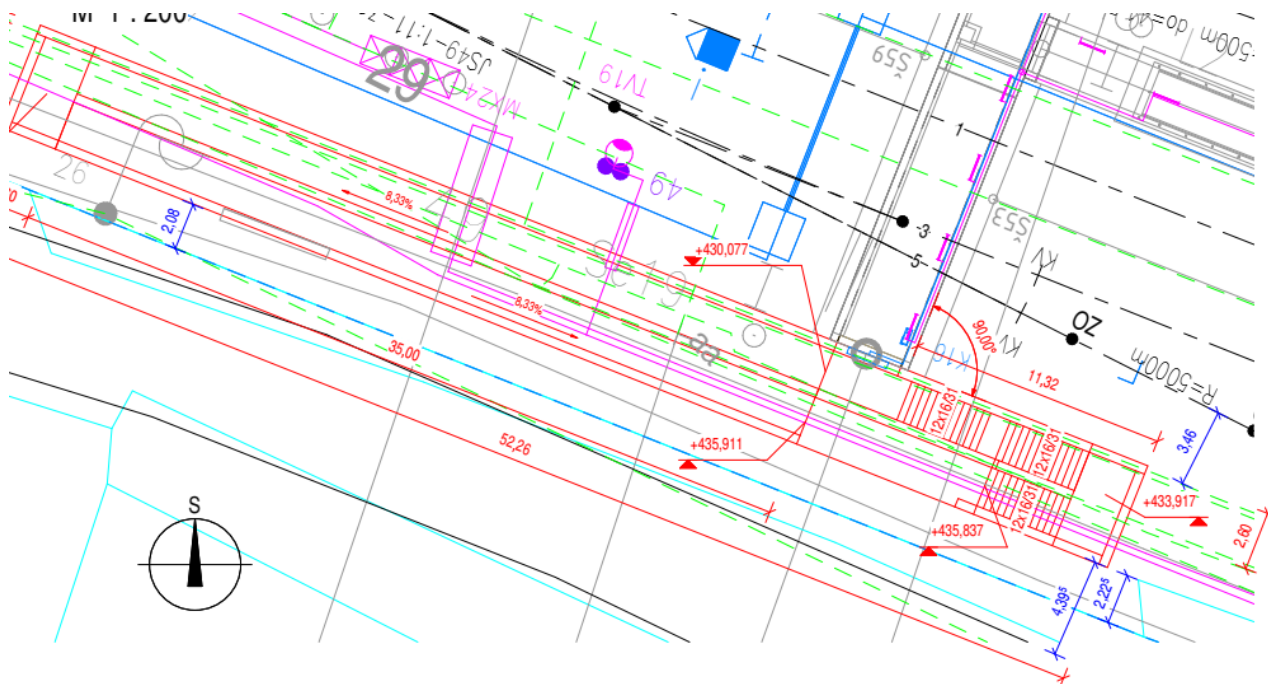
Varianta 2 (Rvz – rampa východ - západ)
